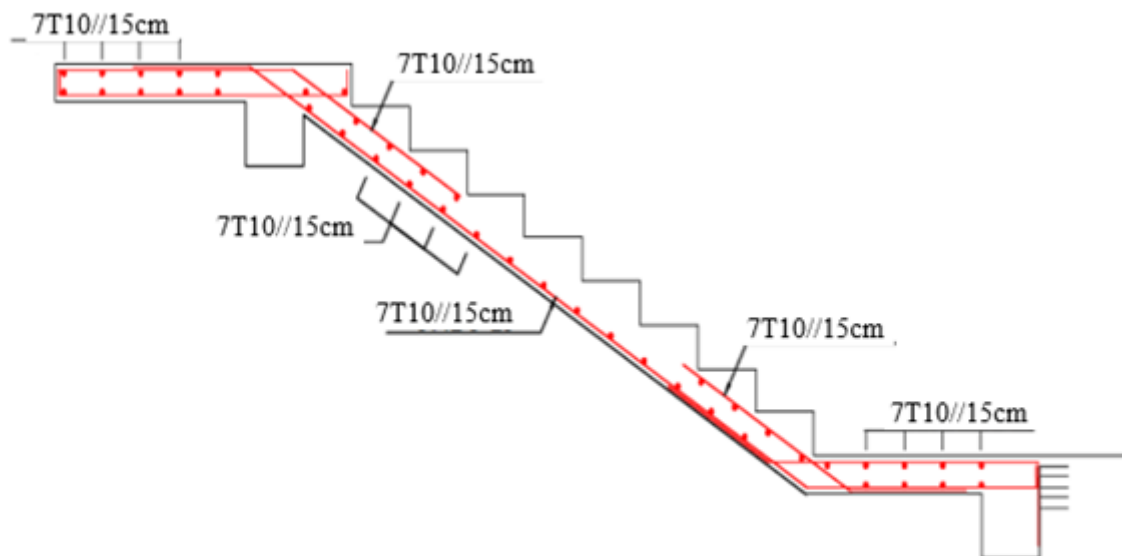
Schéma de ferrailage pour L'escalier étage courant.
